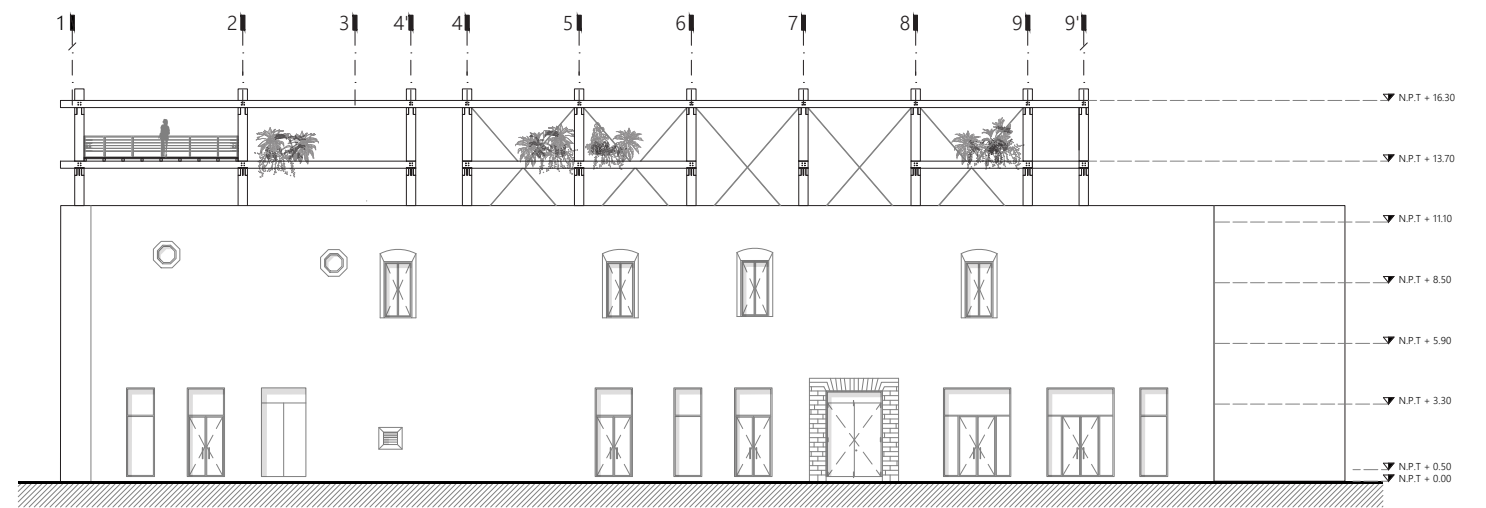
Fachada oriente con preexistencia. Fuente: Elaboración propia.
